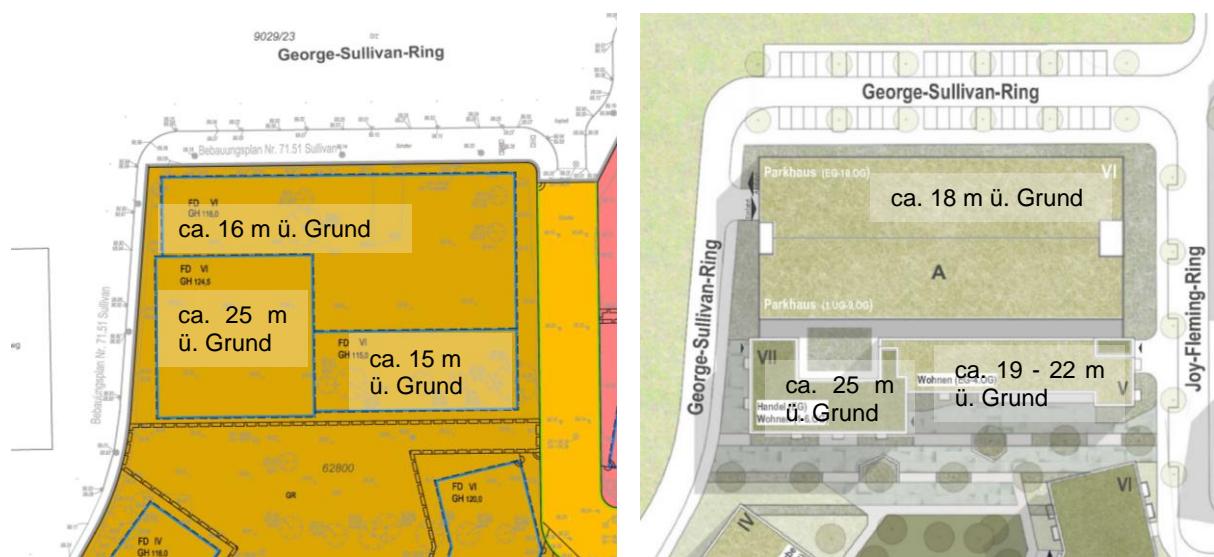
Detail der nordwestlichen Ecke des Plangebiets mit Anzahl der Vollgeschosse (links Bebauungsplan 2024 /1/, rechts aktuelle Planung /2/)
